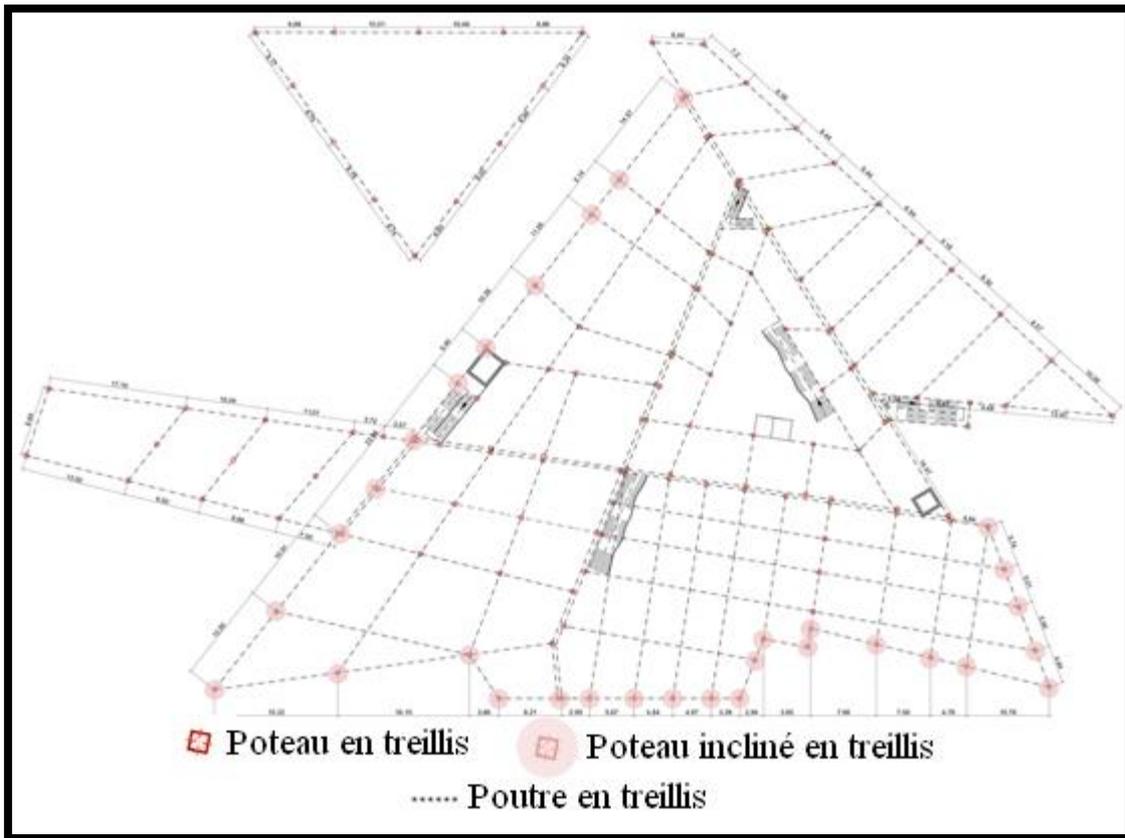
Emplacement des poteaux et poutres (plan de structure)
